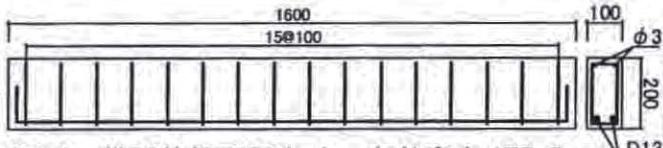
供試体概要図 (mm) 有効高さ 177.5mm
